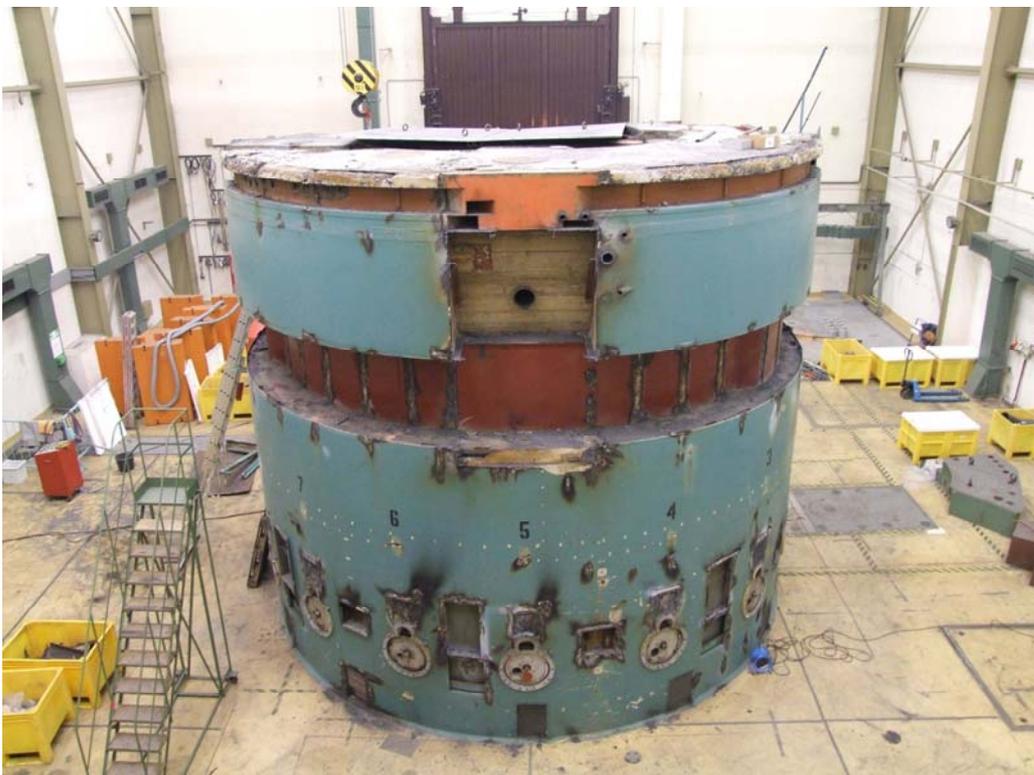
RFR-Baukörper nach Abbau der äußeren Anbauten
